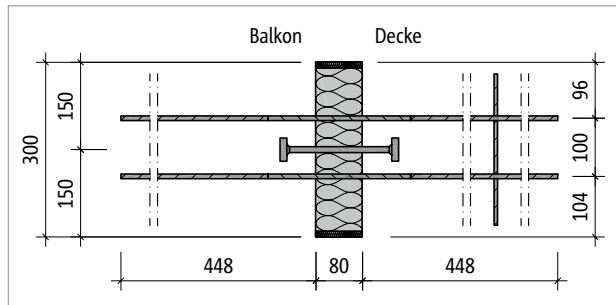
Schöck Isokorb® T Typ QP-V1: Produktgrundriss
